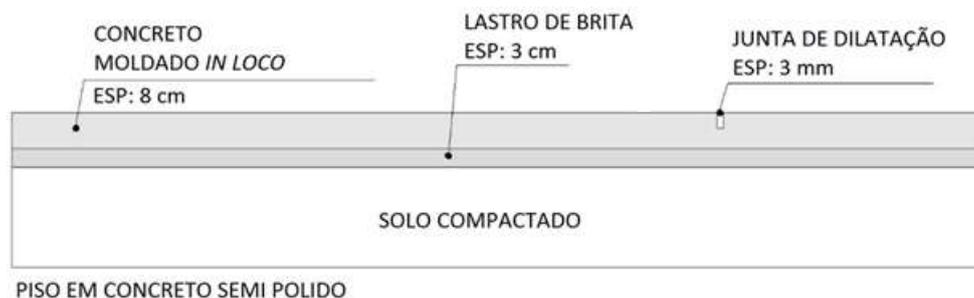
Estrutura em concreto moldado in loco proposta para as calçadas
